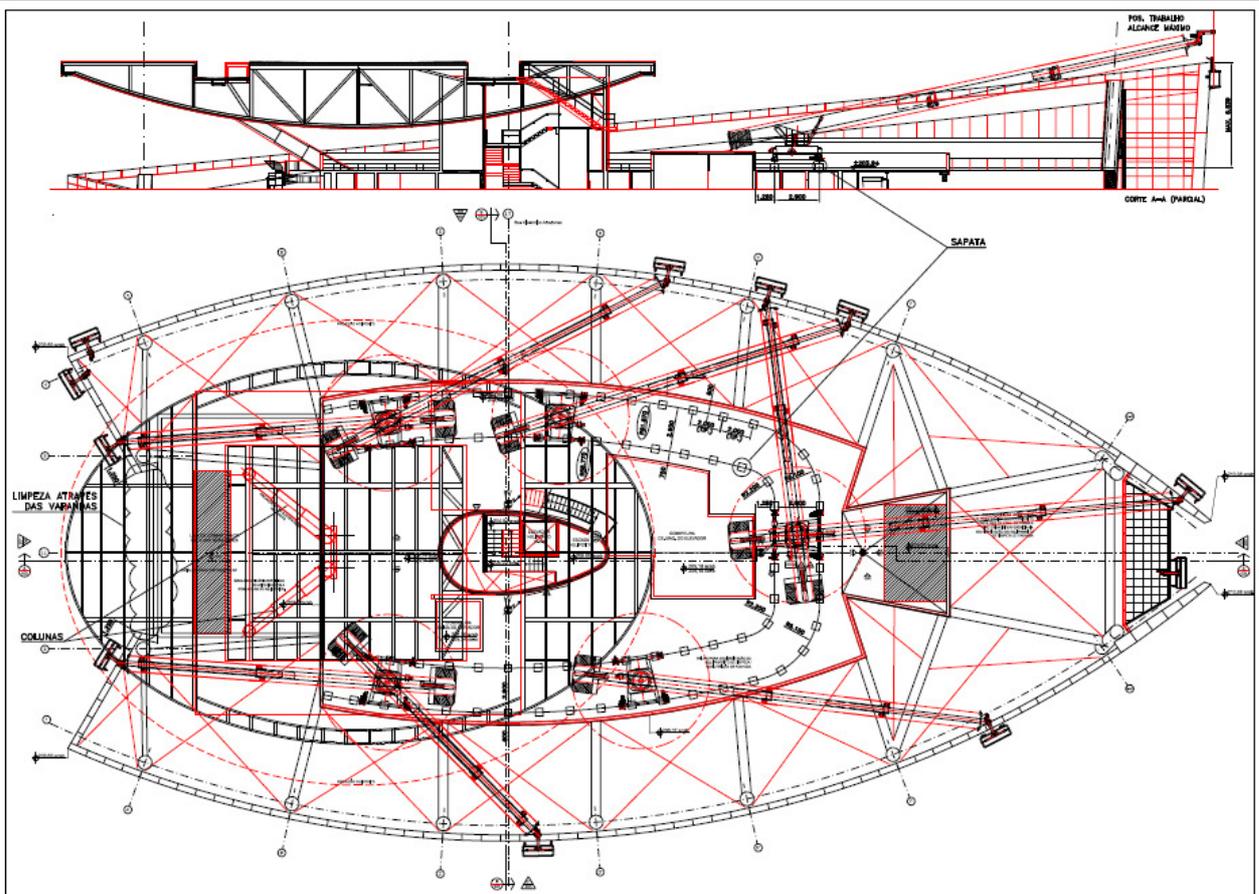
Projeto do sistema de limpeza das fachadas – planta e corte
